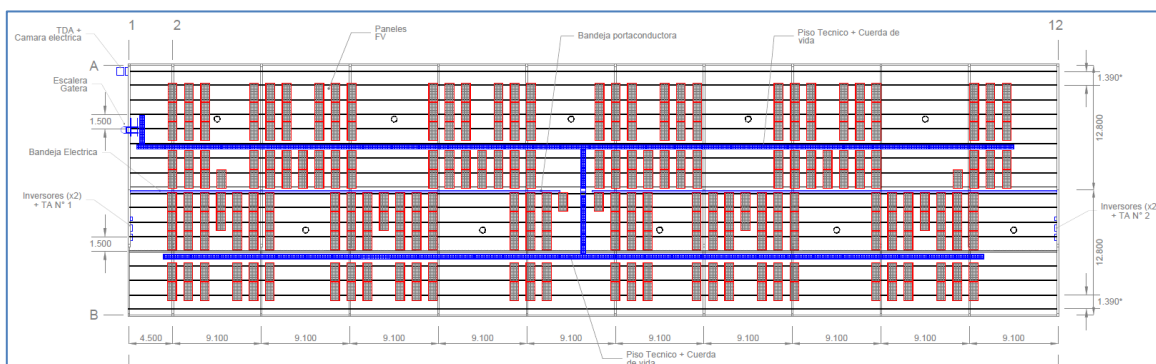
Planta de Techumbre, instalación de paneles.-
